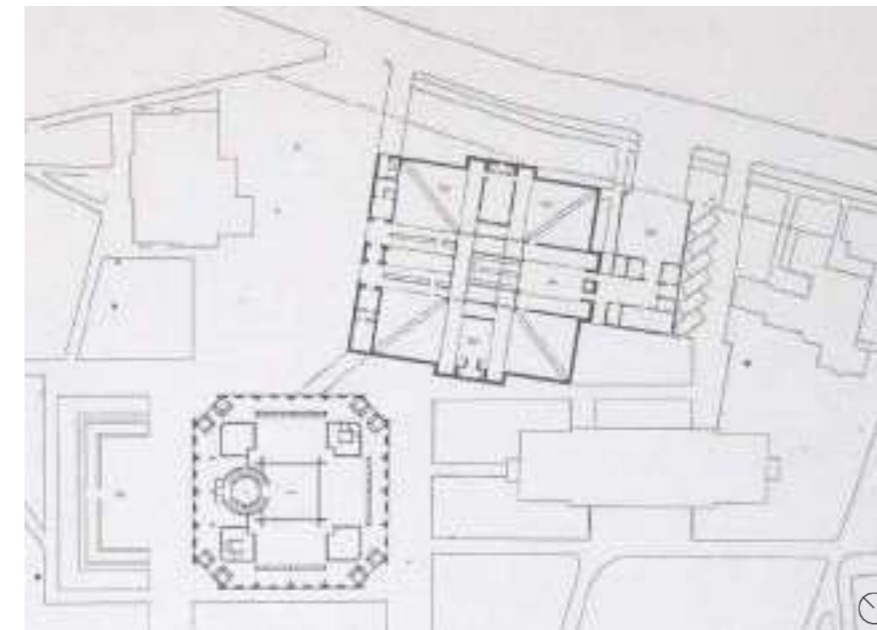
Planta de Implantação de 1967, Louis Kahn.
